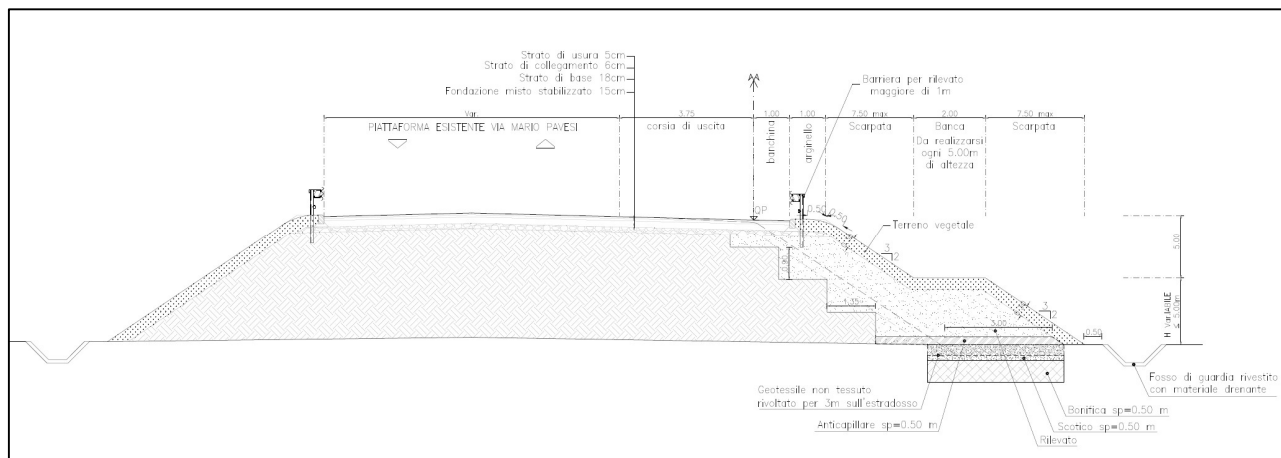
Sezione tipo corsia specializzata con ammassamento su rilevato esistente
